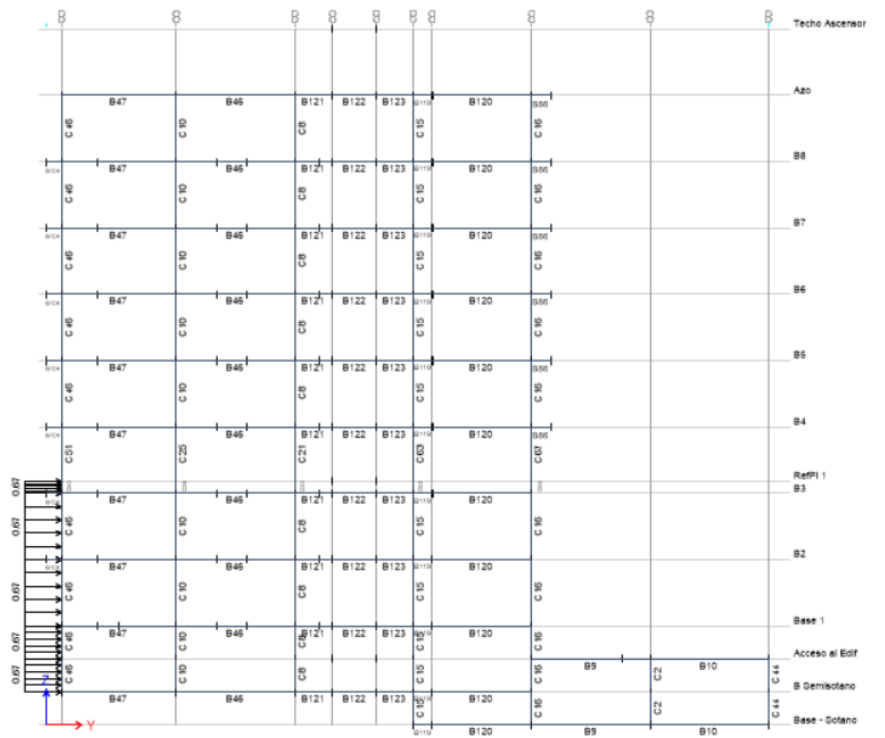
Aplicación de las fuerzas de boyantes en las vigas de manera secuencial entre los elementos estructurales para los edificios “Las Olas” y “Spondylus”.
